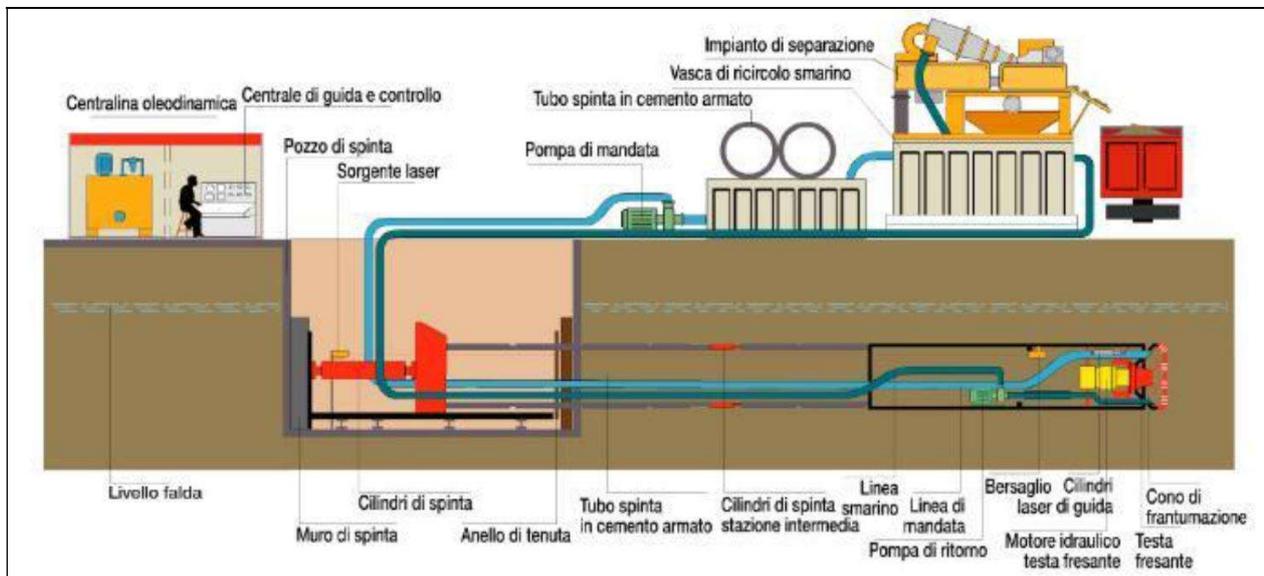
Fasi tipiche della realizzazione di un attraversamento tramite microtunnelling
